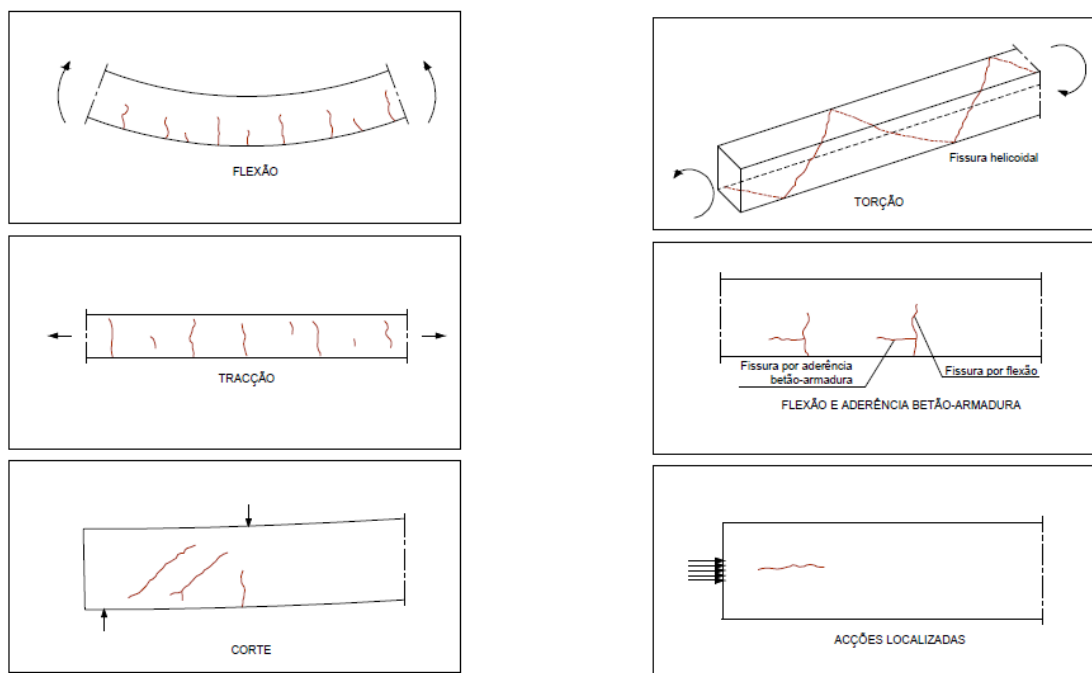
Fissuras associadas aos esforços dominantes (Miranda, 2006).
